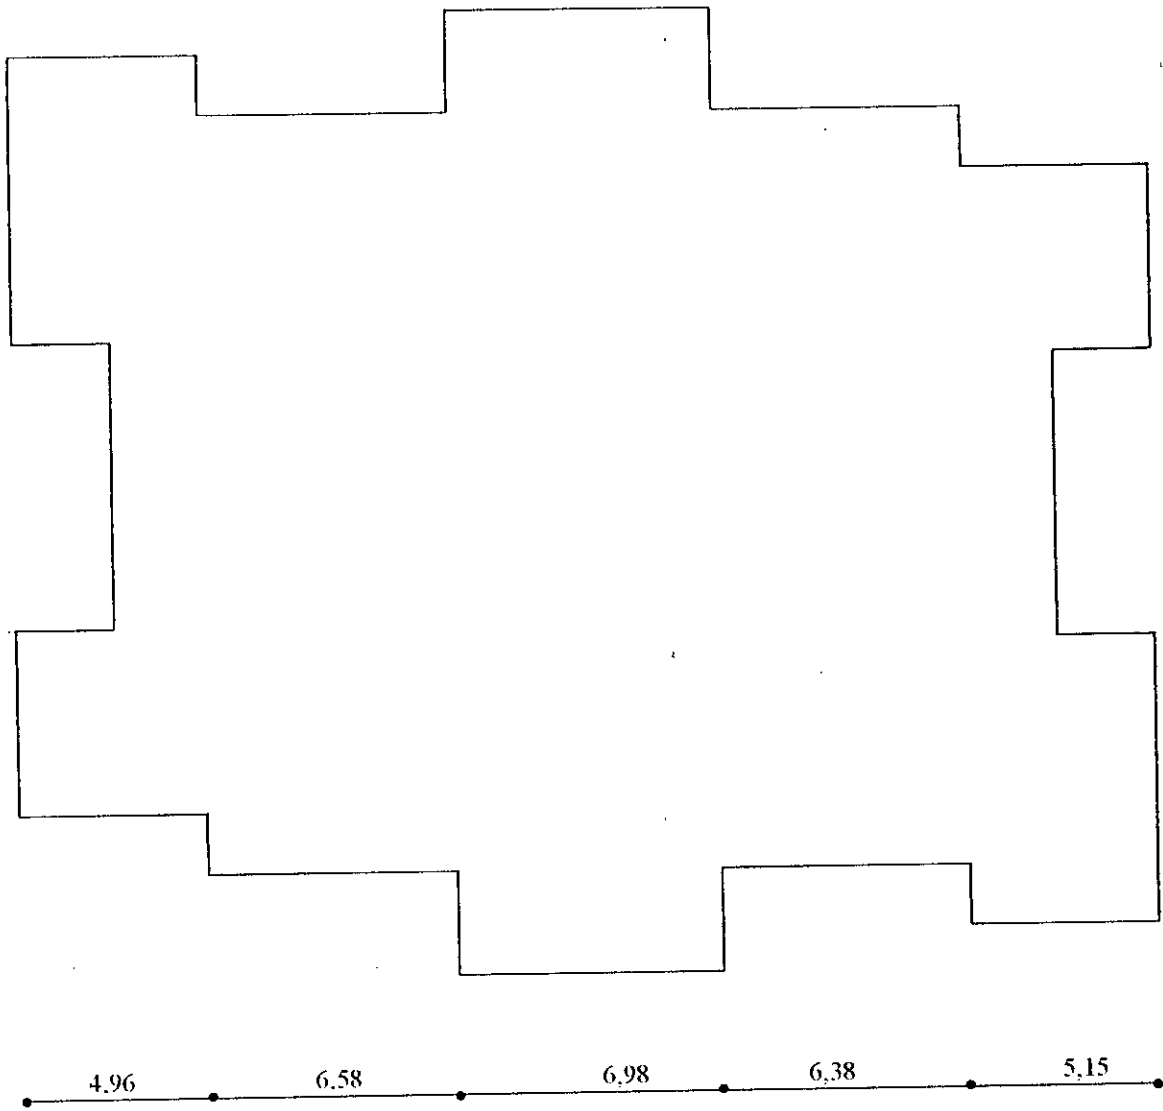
VUE EN PLAN DE LA TERRASSE
